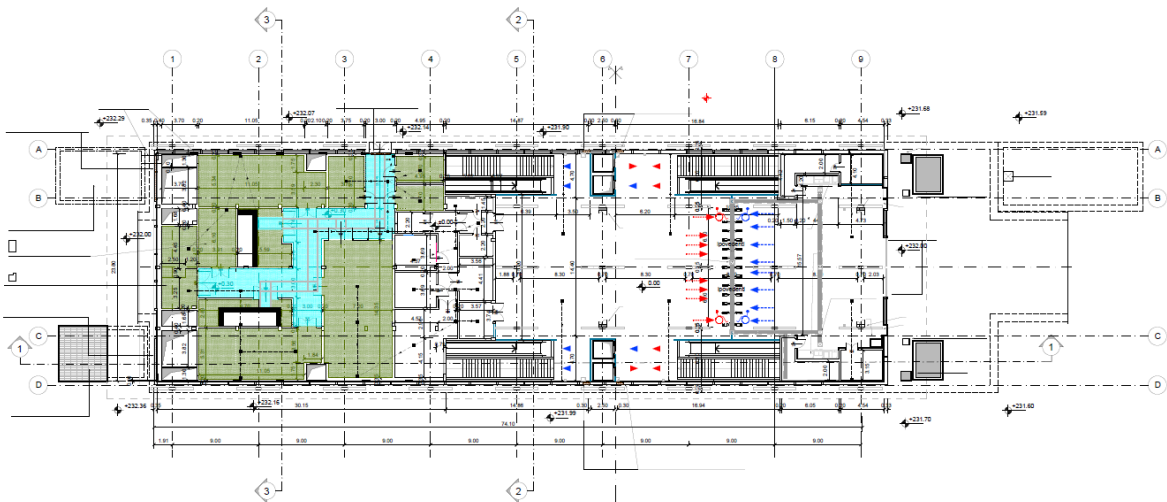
Pianta piano atrio S1L - Stazione Giulio Cesare
